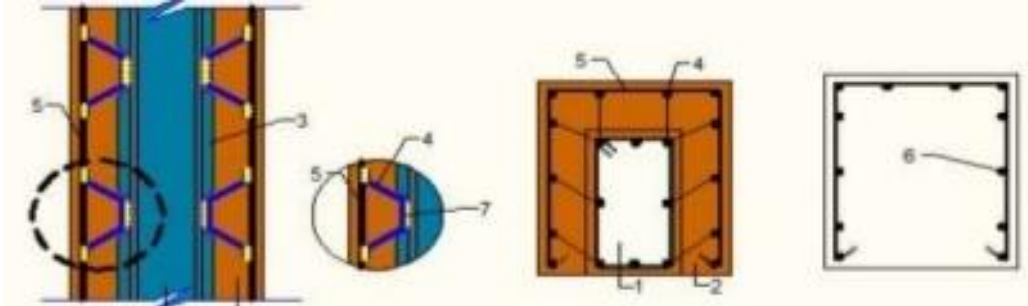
Técnicas de anclaje del refuerzo lateral al núcleo de la columna existente.
